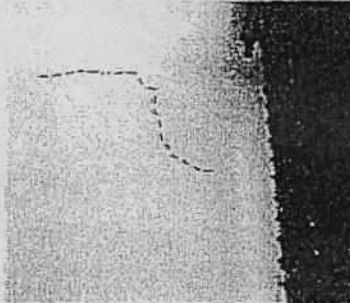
Desprendimiento de pañete muro de antepecho apartamento 404 torre costado sur.
